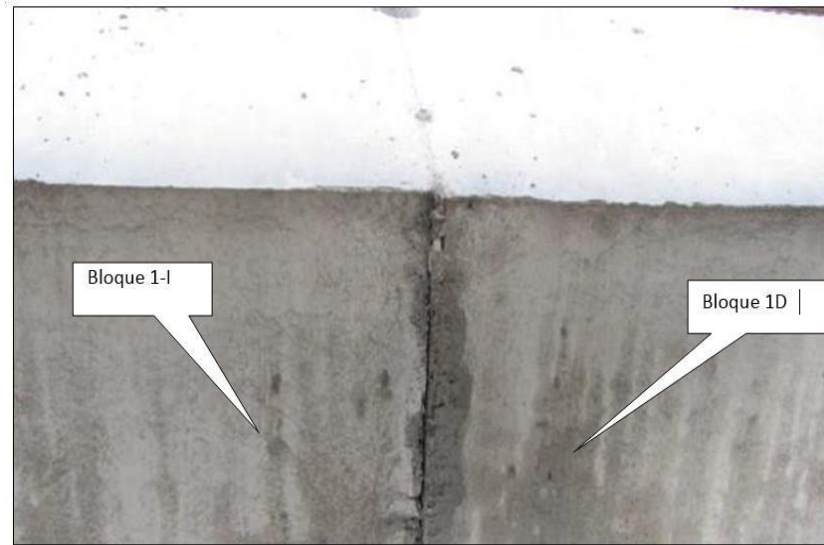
Junta inducida en el bloque de concreto – Primera prueba
